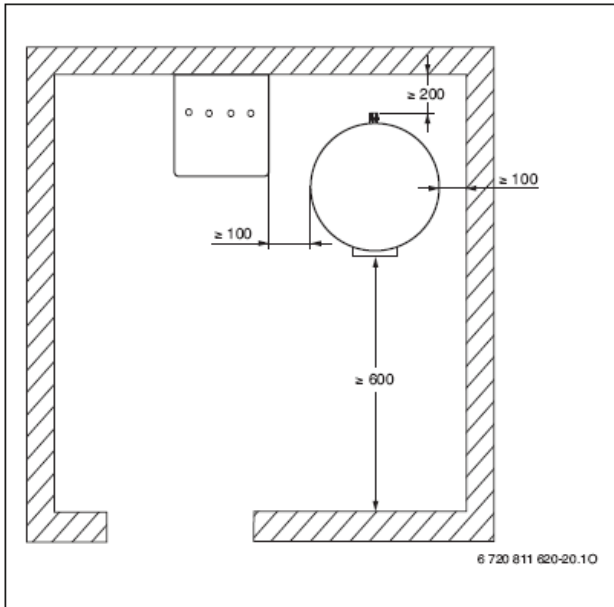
Установочные размеры для баков-водонагревателей SH290 RW, SH370 RW и SH400 RW (размеры в мм)
